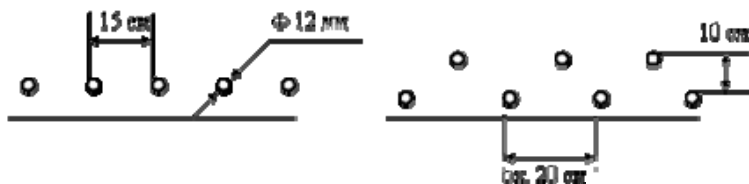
Размещение отверстий для инъекций в стену при выполнении горизонтальной гидроизоляции
